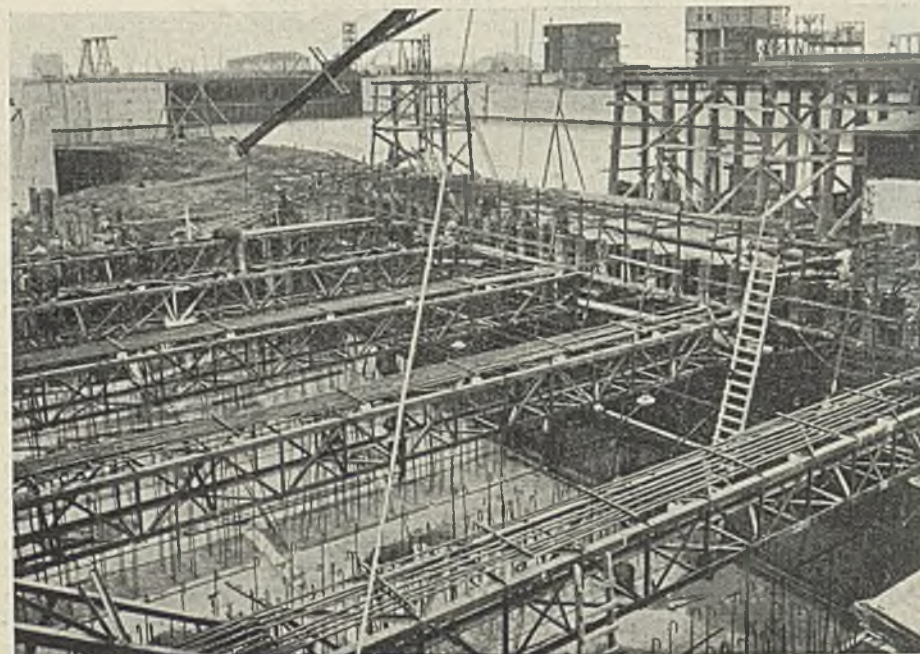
Block 9 und 10 der Kajemauer Außenvorhafen-West im Bau, mit eingebauter eiserner Spundwandaussteifung.
